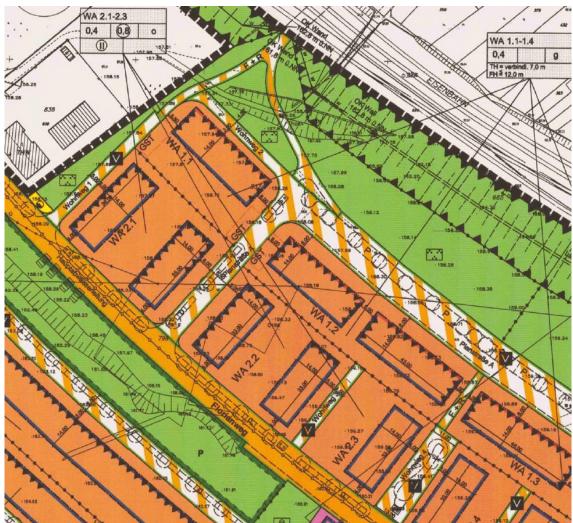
Bezeichnung der Wohnwege im Bebauungsplan 263
